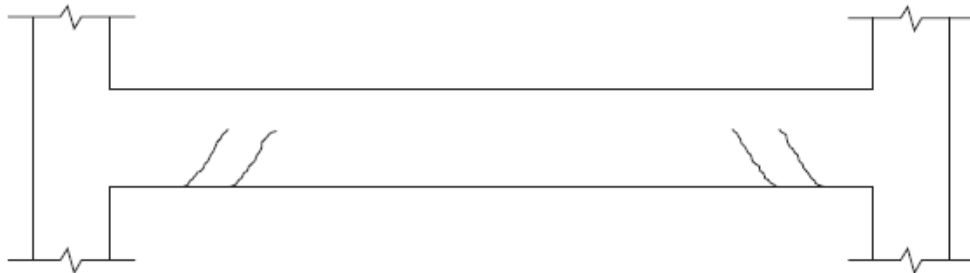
Fissuras em viga causadas por esforços cisalhantes.
